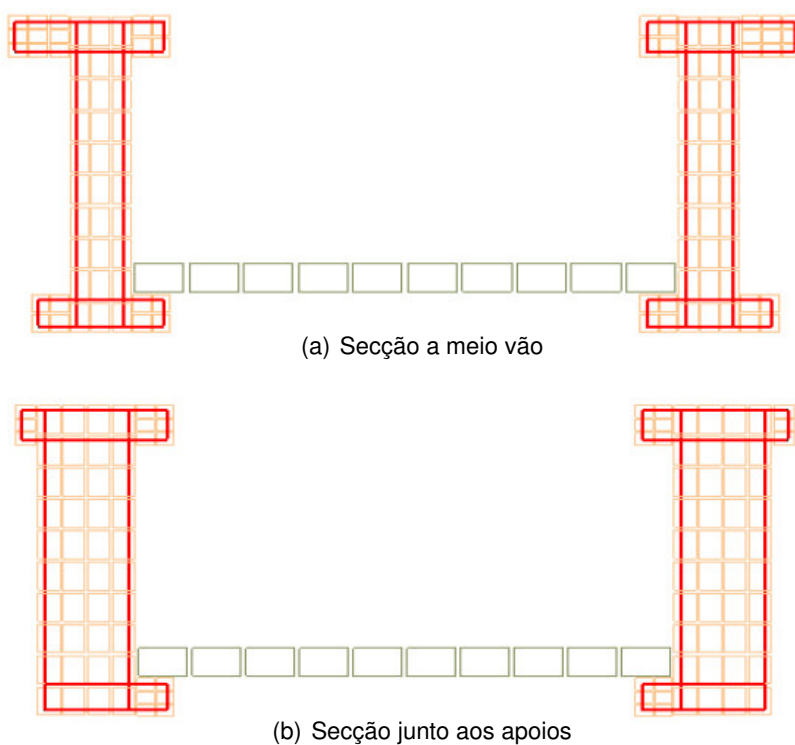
Modelação das armaduras transversais da viga do tabuleiro
